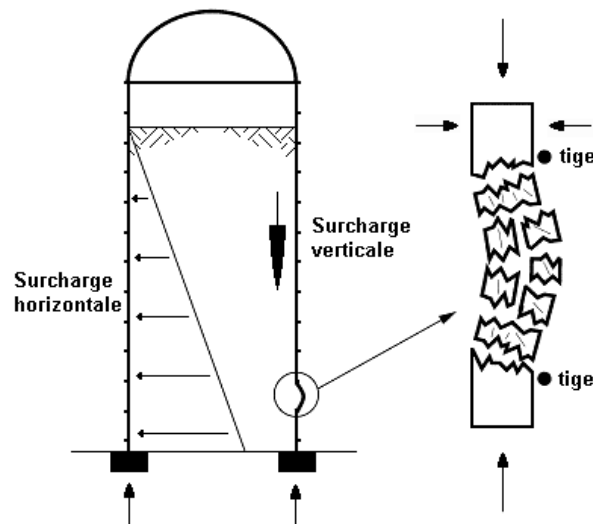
Mécanisme de détérioration d'un silo d'ensilage (MAAAROa 2008)
